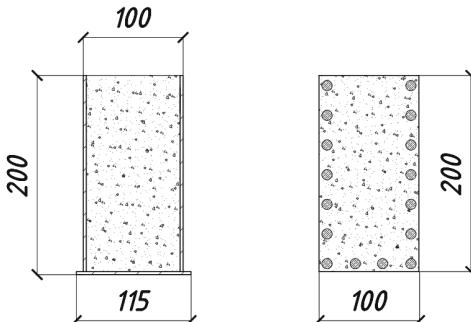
Переріз сталезалізобетонного елемента із зовнішнім листовим армуванням та розрахункова схема
